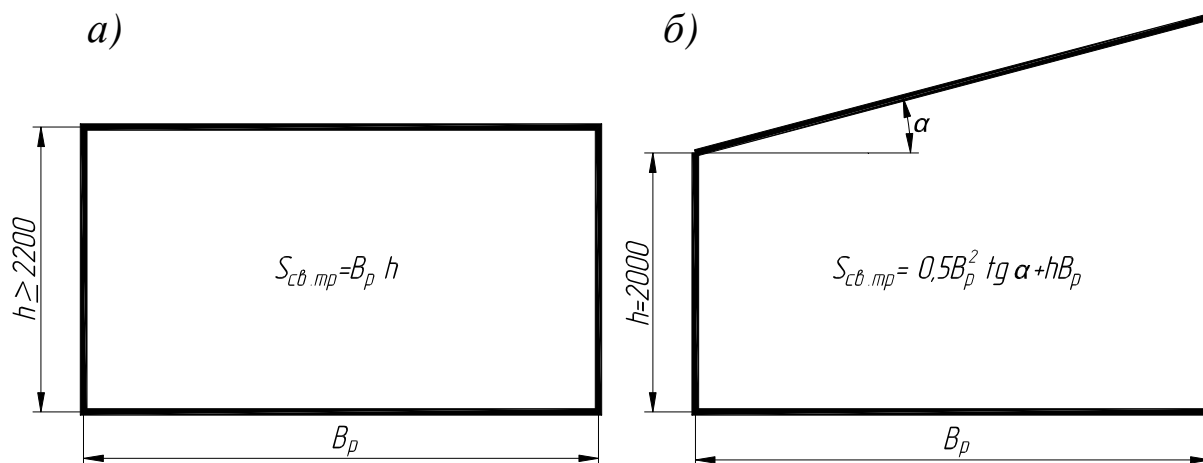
Расчетные схемы для выработок с анкерной крепью:
